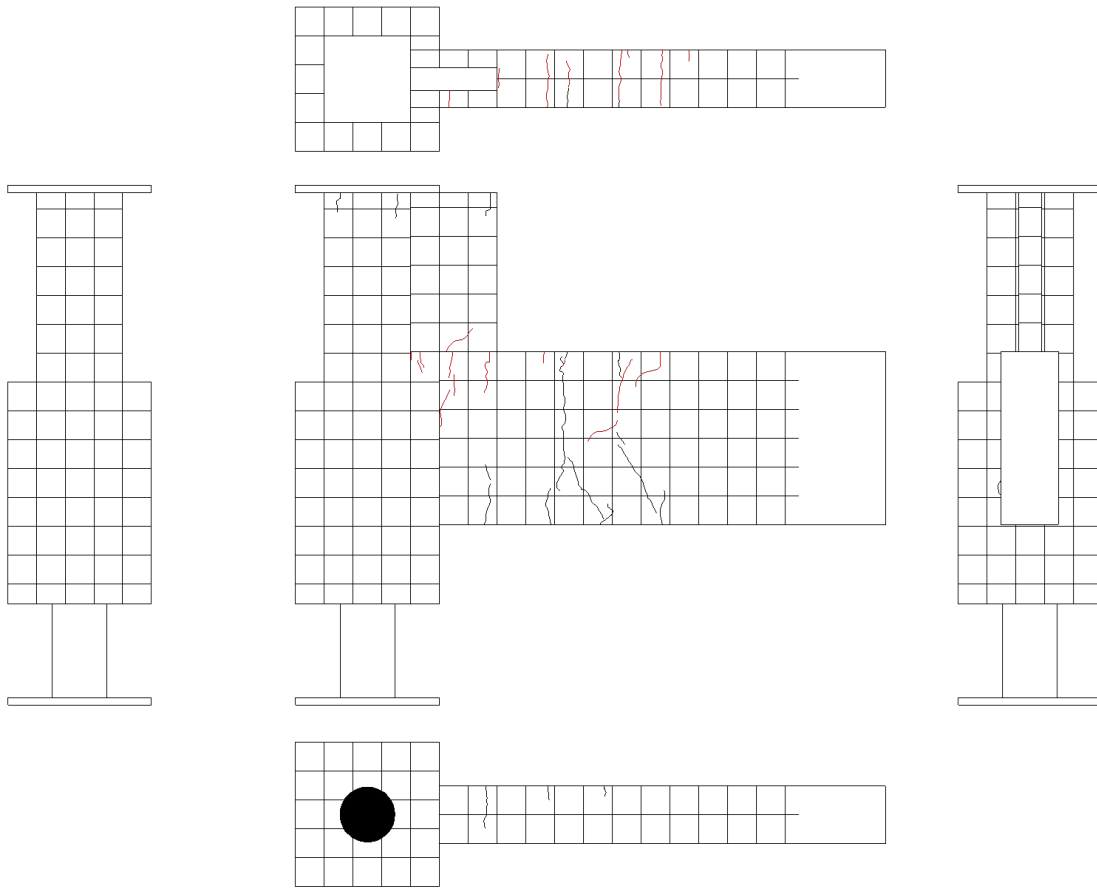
試験体 A-3 ひび割れ状況 (10Cycle)
